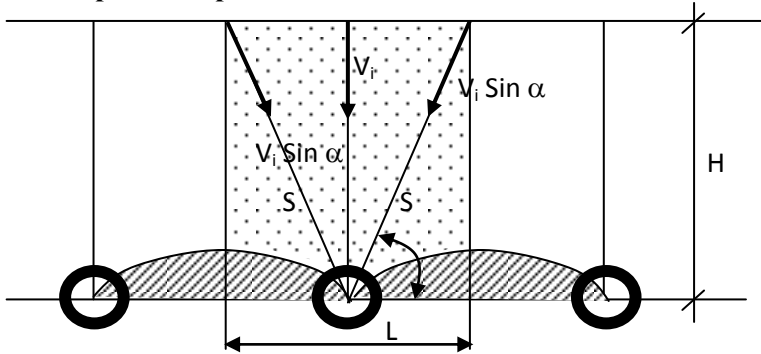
Sket Definisi Penentuan Jarak Pipa Drain
